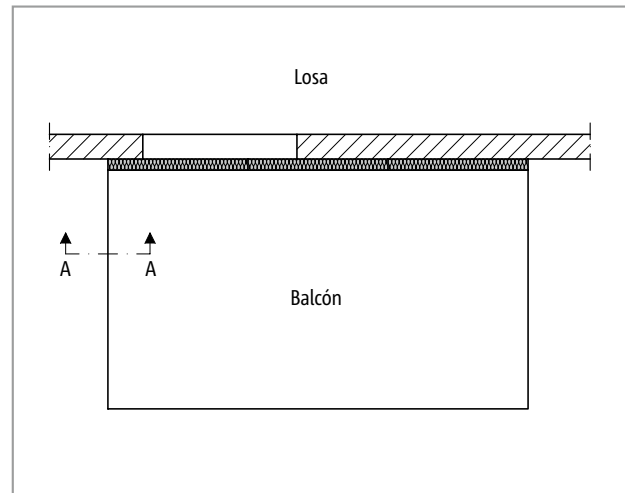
Schöck Isokorb® T tipo K: Ilustración de la posición de sección A-A
